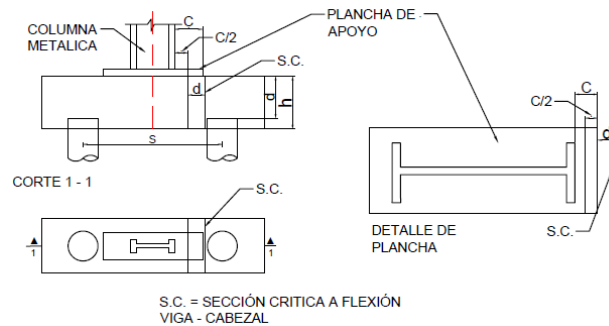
Esfuerzos cortantes en una columna metálica sin pedestal.
